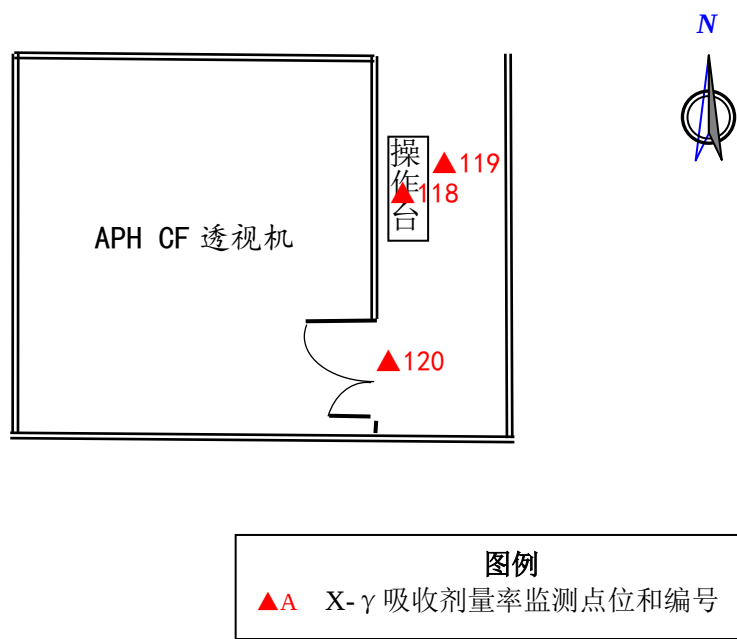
APH CF 透视机房平面布置简图及监测点位图
